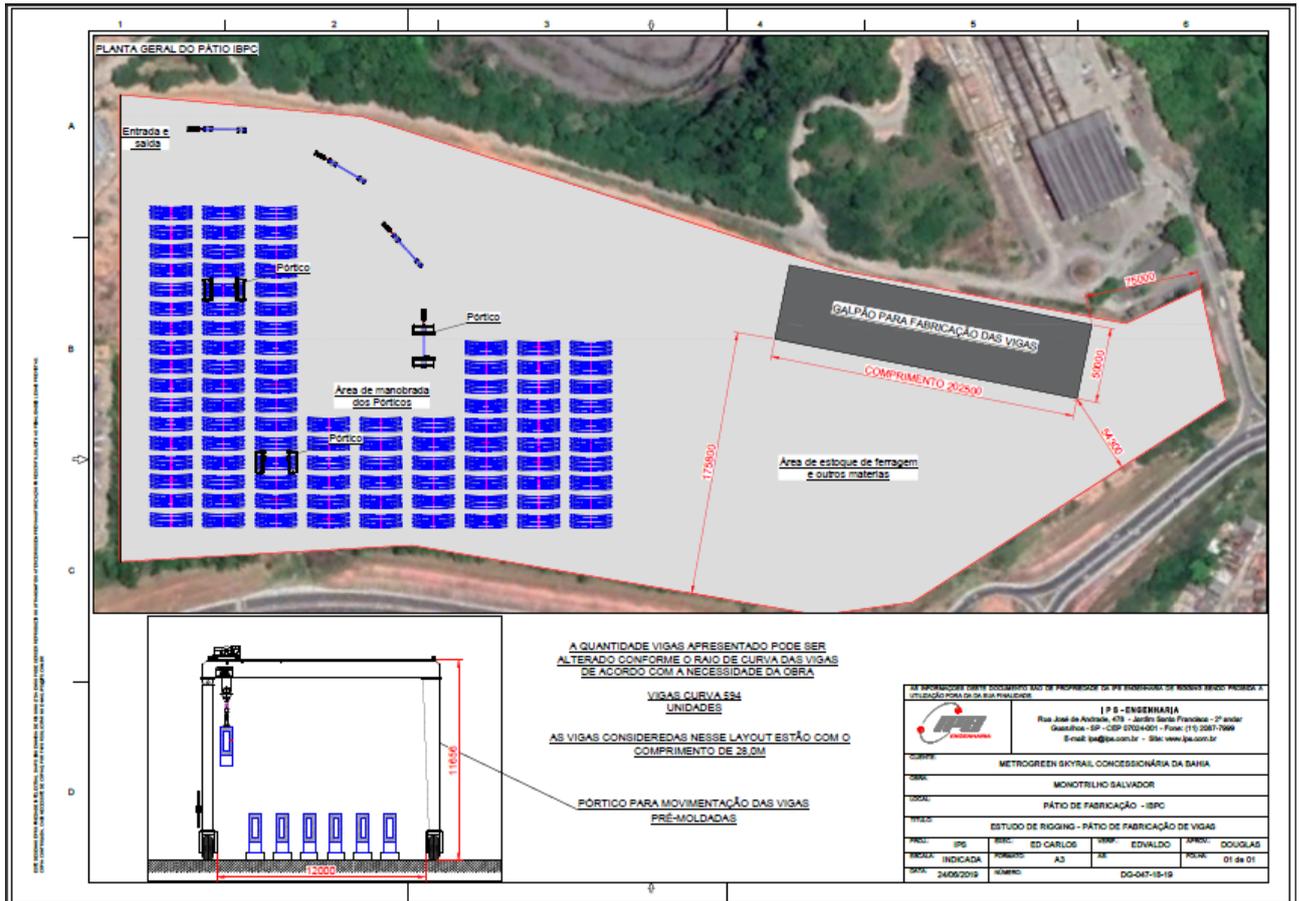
Layout do Pátio de Pré-moldados.
